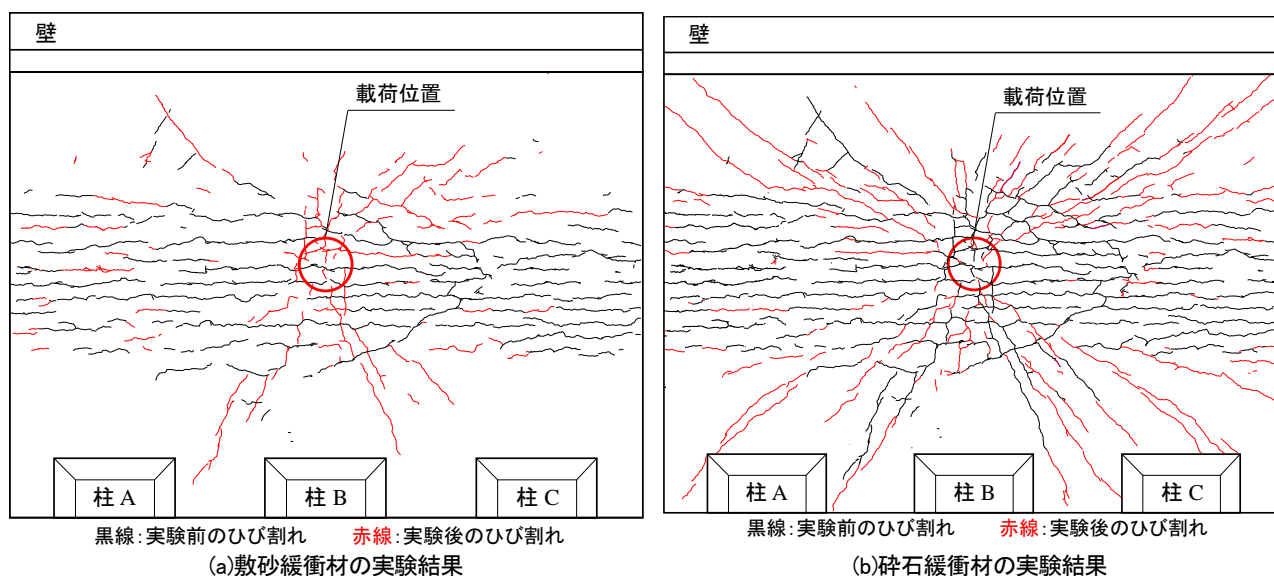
各実験後の頂版裏面ひび割れ性状(見下げ図 E1,500)
